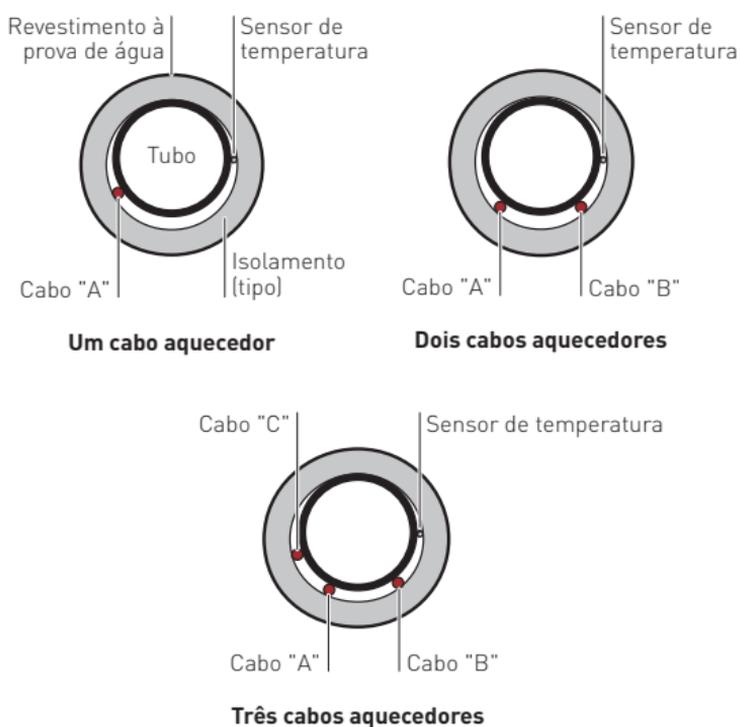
Posicionamento do cabo aquecedor SC (corte transversal típico)
